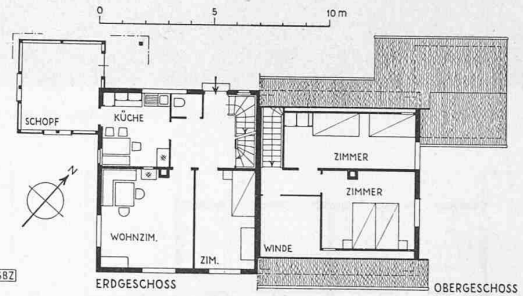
Grundrisse 1:300 des Doppel-Knechtehauses
